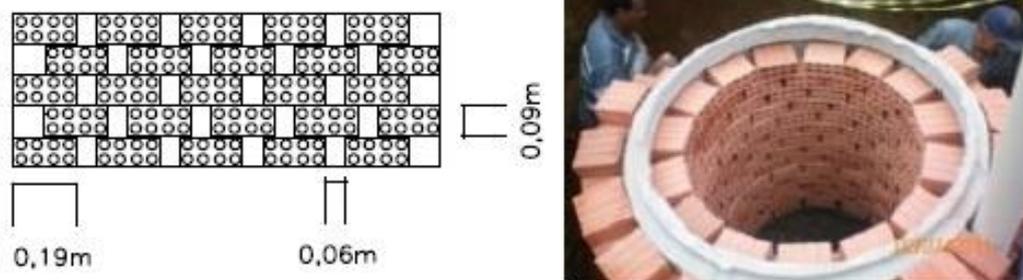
Exemplo de poço drenante com tijolos assentados em crivo (Fonte: diversas)
